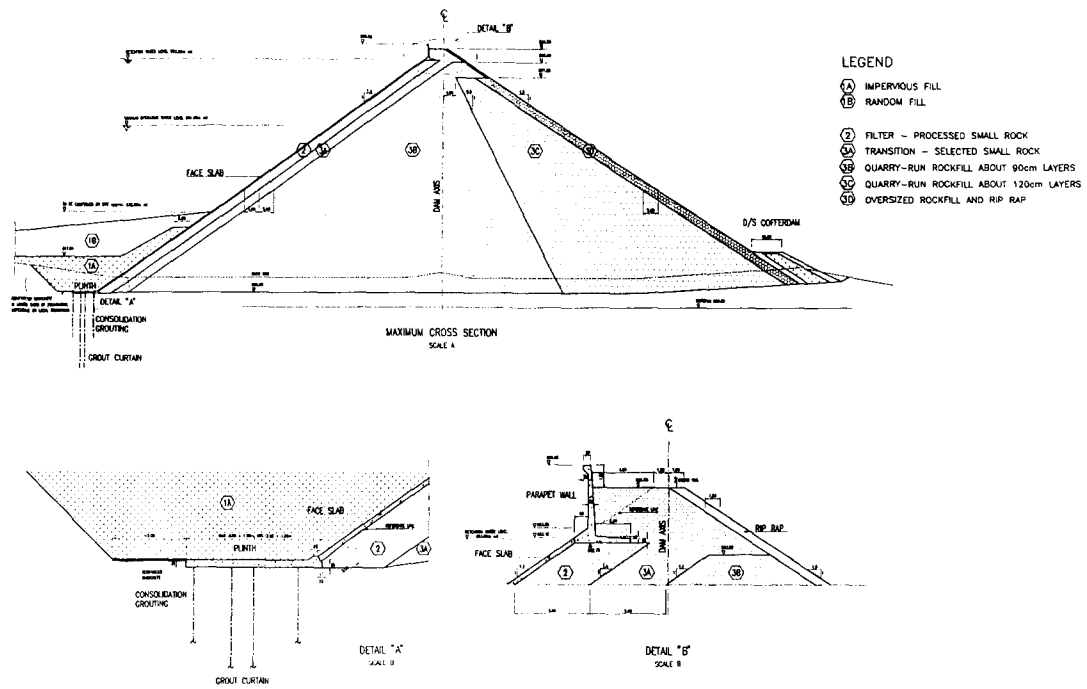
댐 표준단면 (Concrete Faced Rockfill Dam)
